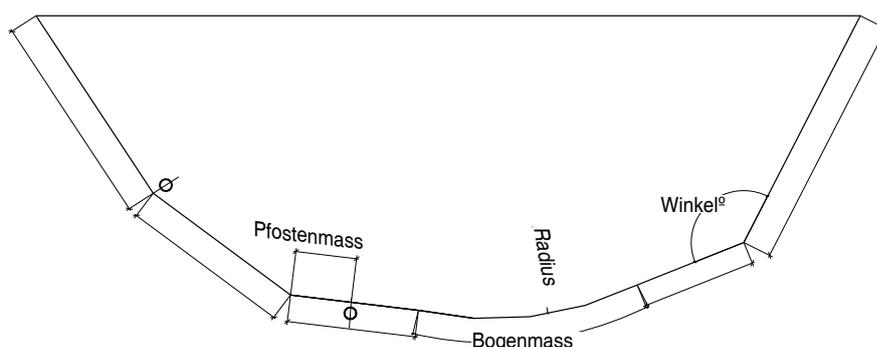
Grundrissermittlung für Balkon- und Brüstungsgeländer
